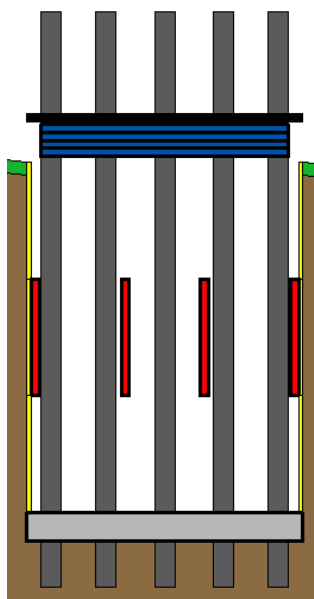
Устройство монолитной фундаментной плиты.
